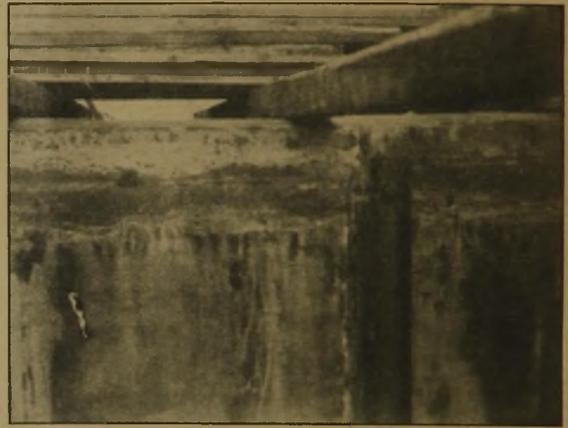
(oben). Ausgestemmte schadhafte Stelle. Anbringung neuer Bewehrungsseisen.
